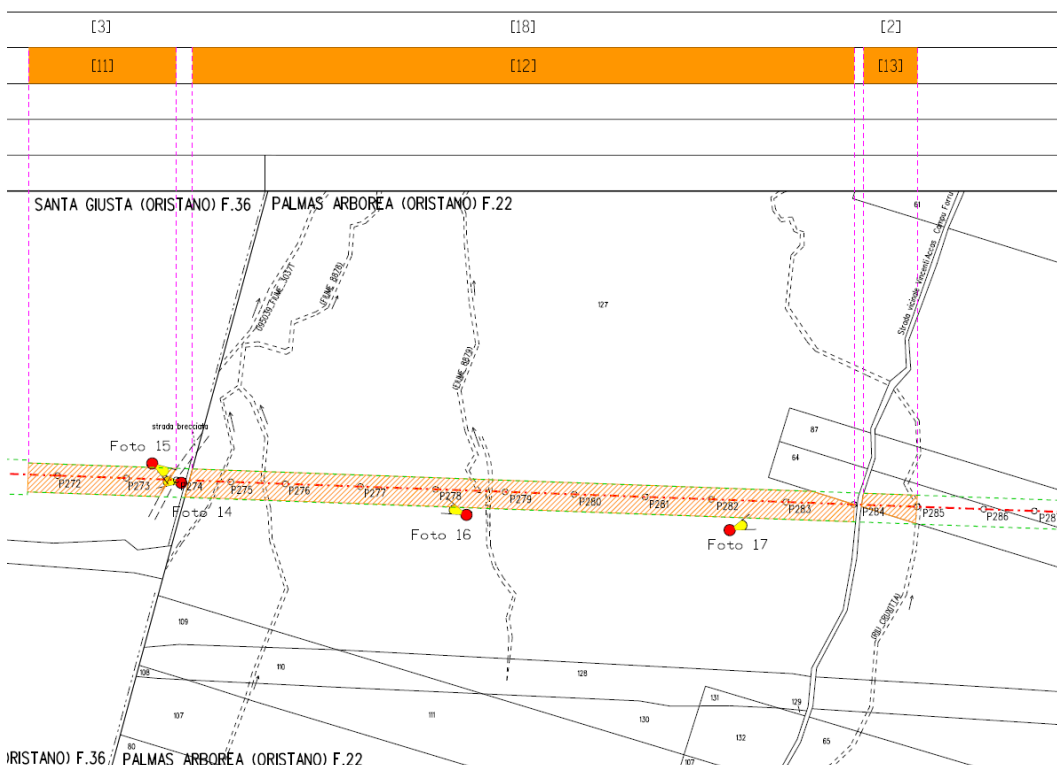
P284- P285 - la zona delimitata dalle linee verdi la fascia ristretta di lavoro per come previsto dalla GASD C 13.40.10.02
